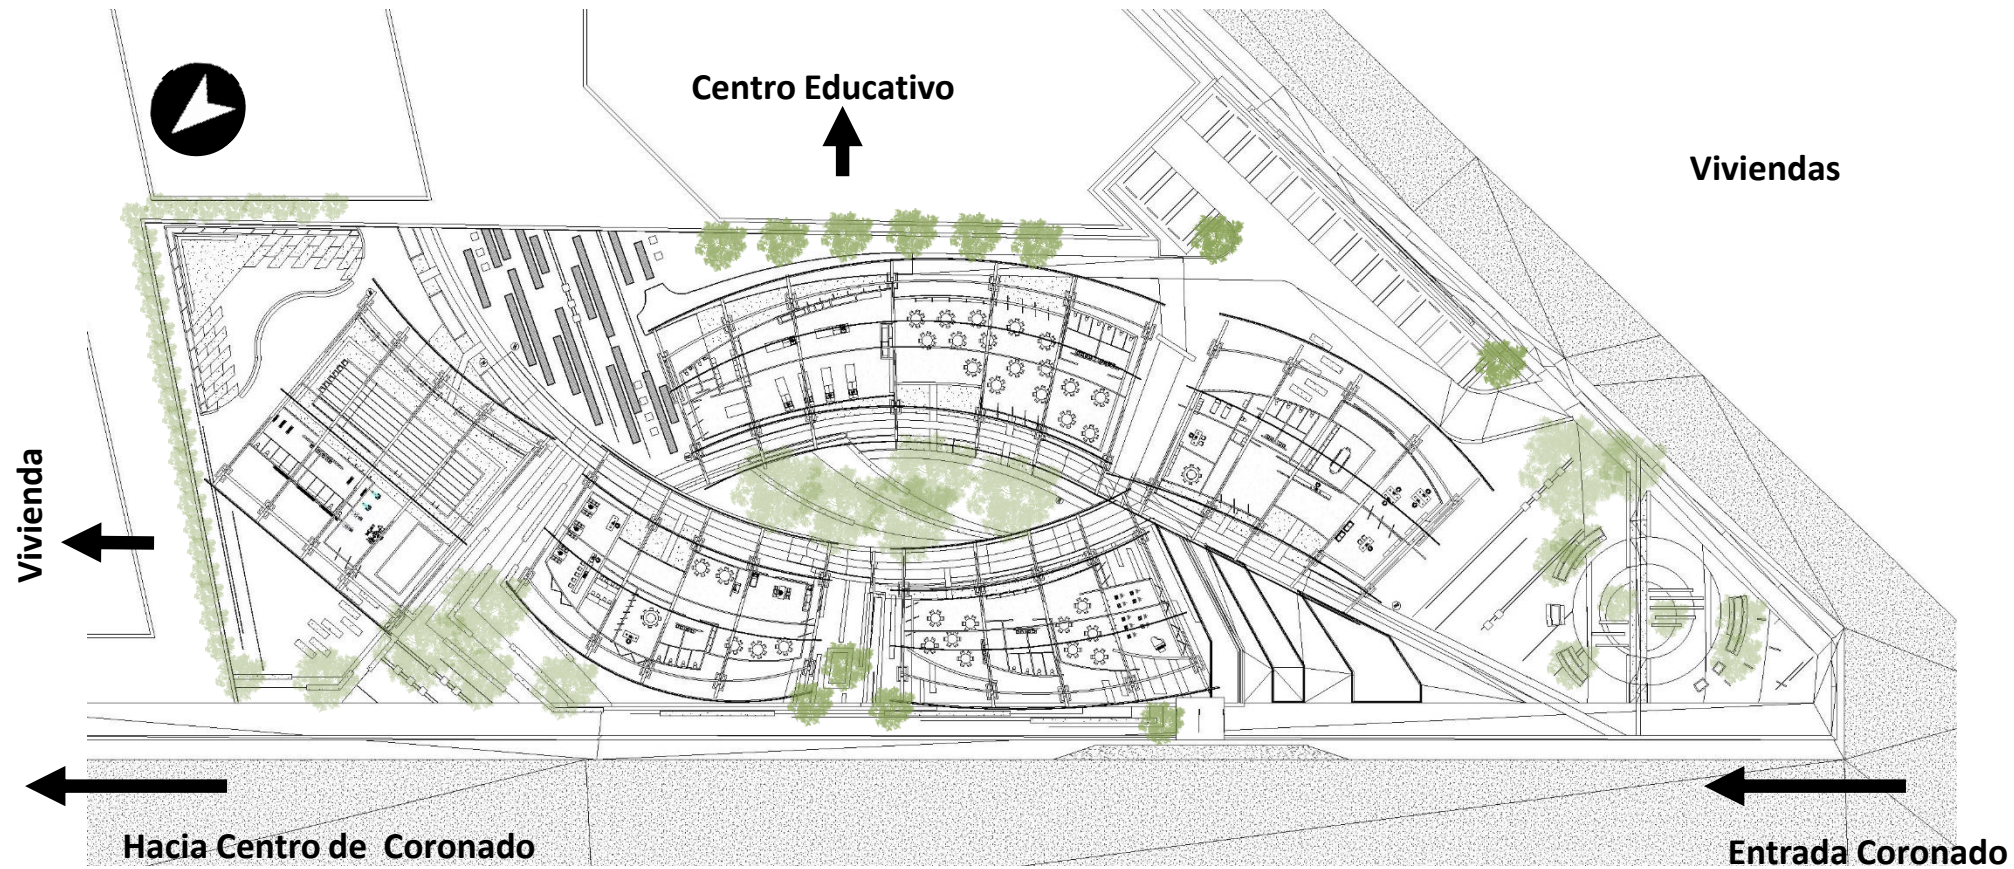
Planta Arquitectónica Estructura Cubiertas. Rojas Vargas, A. (2018).
